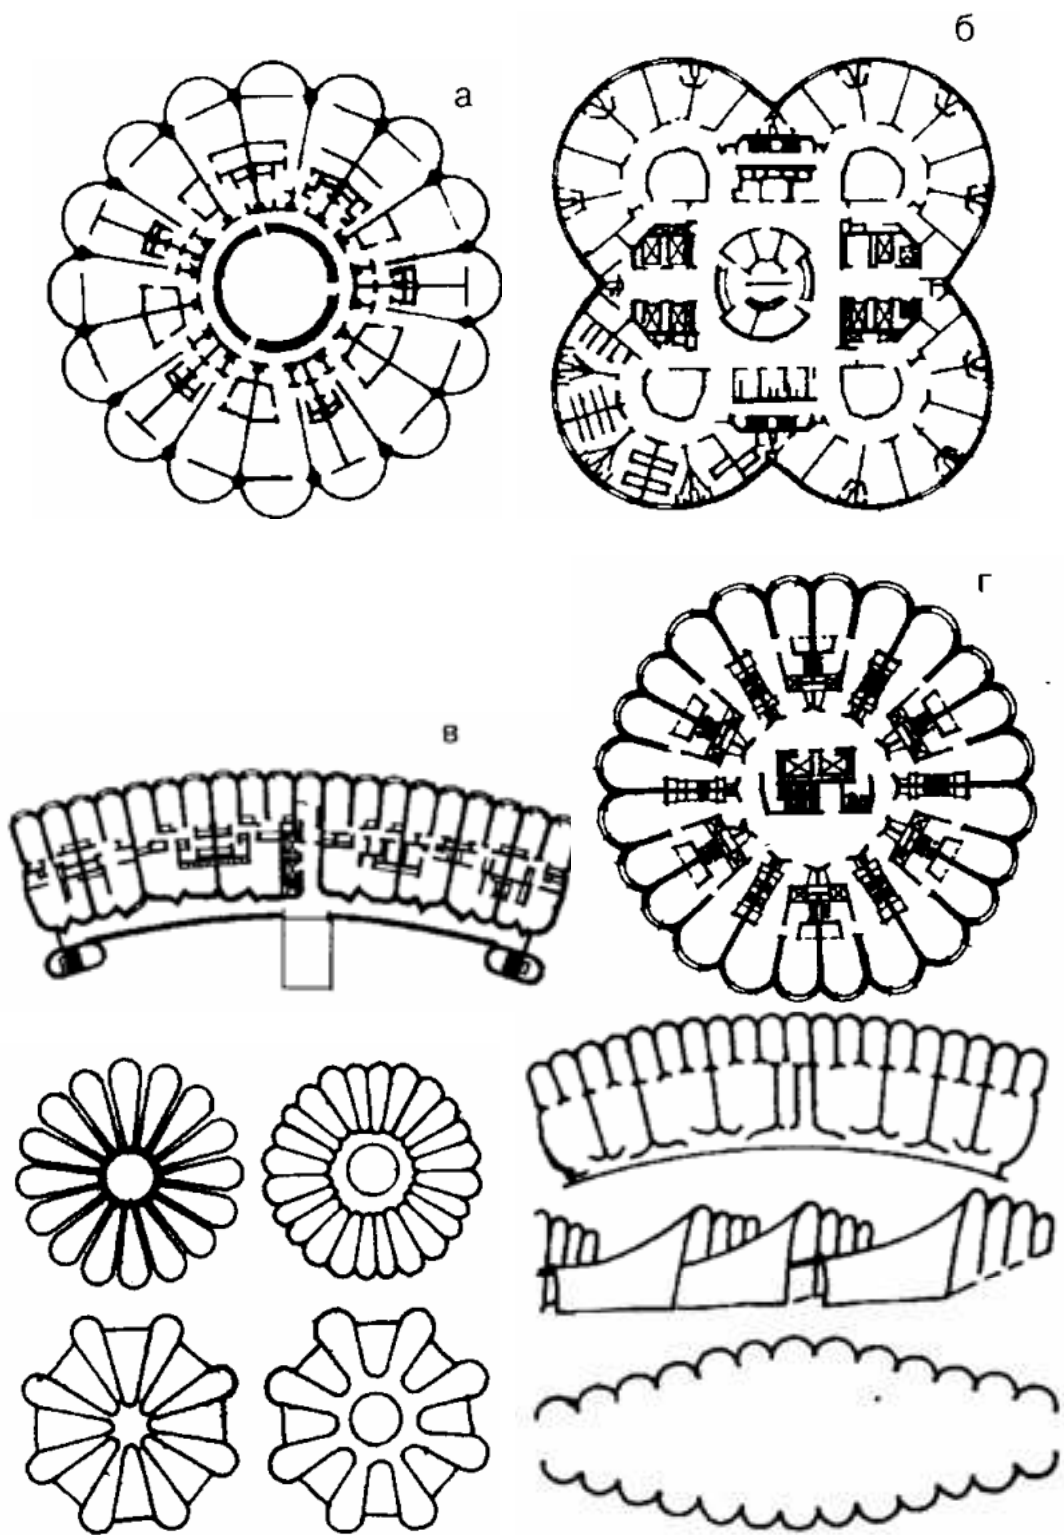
Плани будівель монолітного будівництва (опалубка, що сковзає вертикально переміщувана опалубка)
